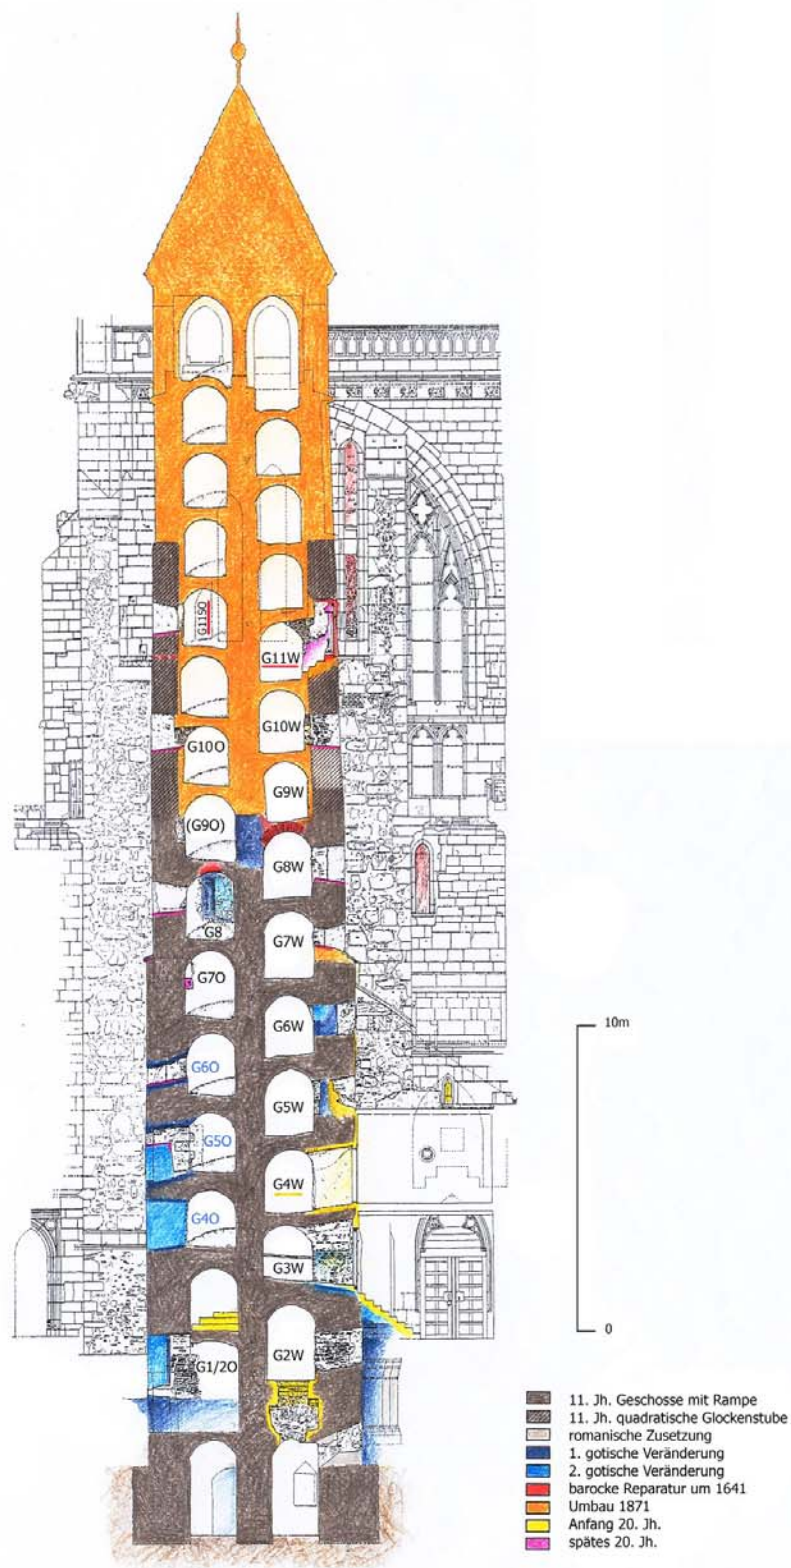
Eselsturm, Schnitt nach Süden: Baualtersplan.
